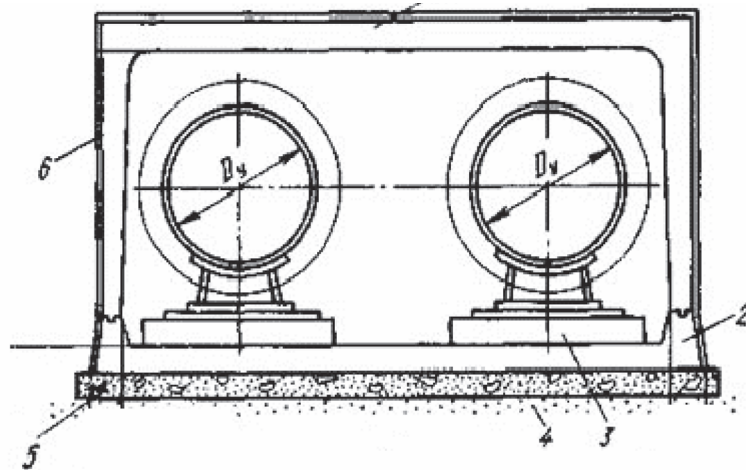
Теплотраса в залізобетонному непрохідному каналі [8]: 1 – залізобетонна рамна секція; 2 – залізобетонна плита; 3 – опора; 4 – піщана подушка; 5 – бетонна подушка; 6 – шар гідроізоляції
